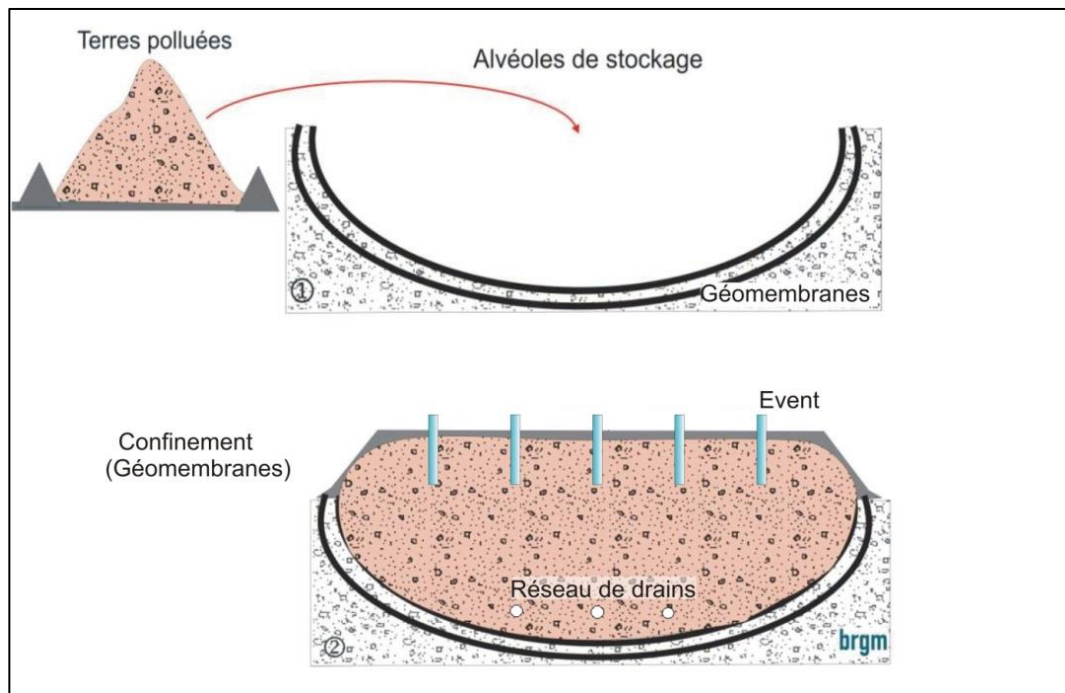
Figure F : Coupe de principe – Confinement sur site (source : BRGM)
